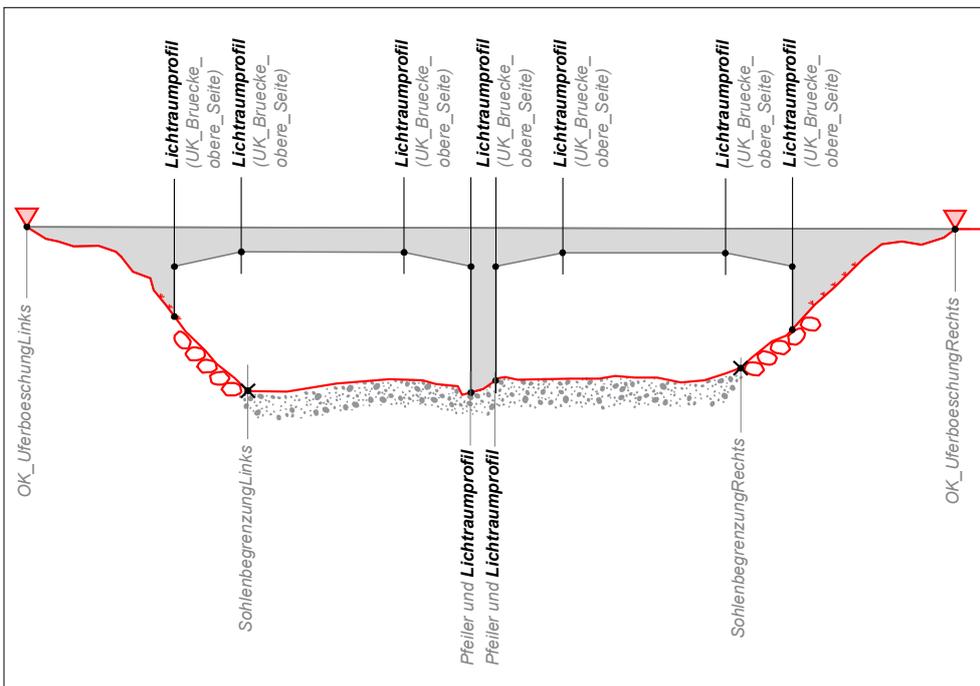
Lichtraumprofil bei Brücken mit Pfeilern.
